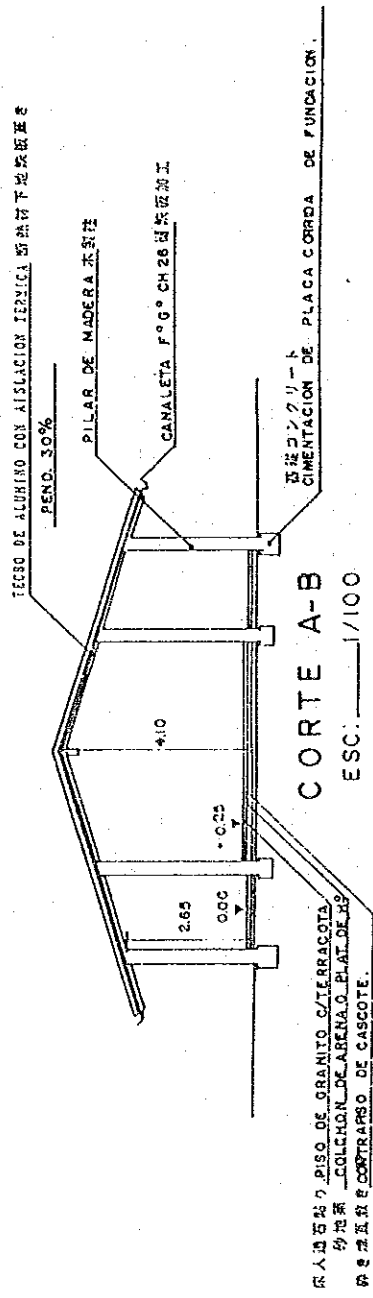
(3) 新築試験場 管理・研究棟 立面図 断面図
